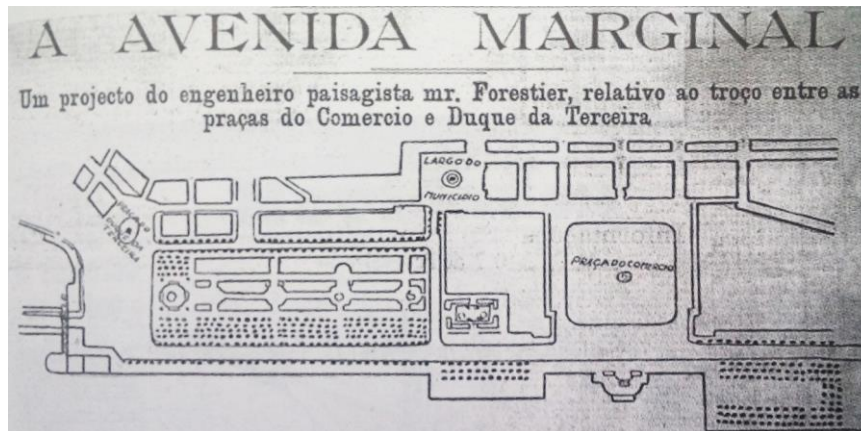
FORRESTIER, Jean Claude – Planta do projeto de uma avenida marginal
